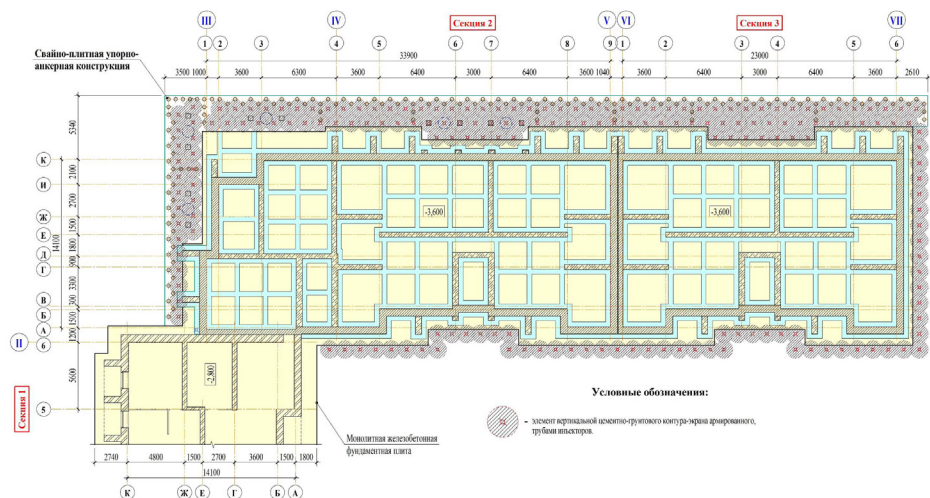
Схема расположения элементов цементно-грунтового контура-экрана по периметру фундаментной плиты
